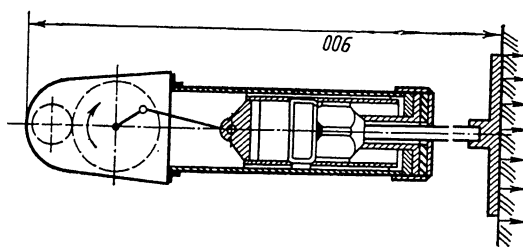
Схема электротрамбовки для уплотнения несвязных грунтов
